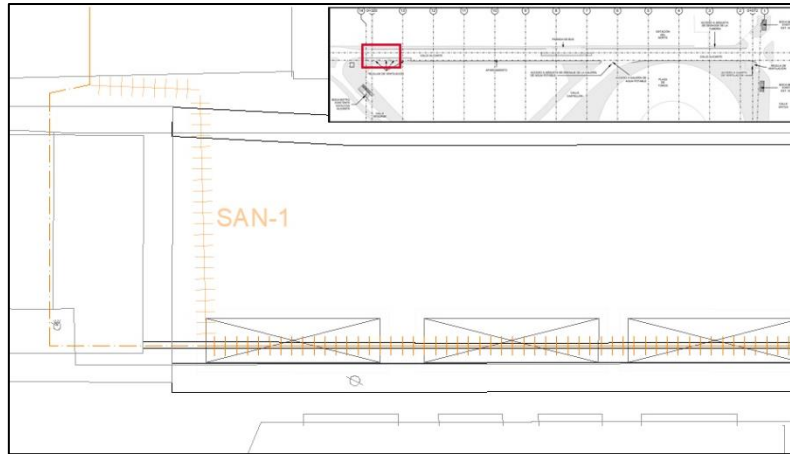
Plano de desvío SAN-SAN1-RP-SC-F1
